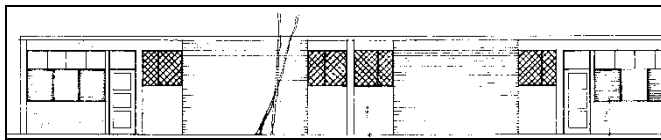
c. Vivienda VL-1. Fachada (1951)
